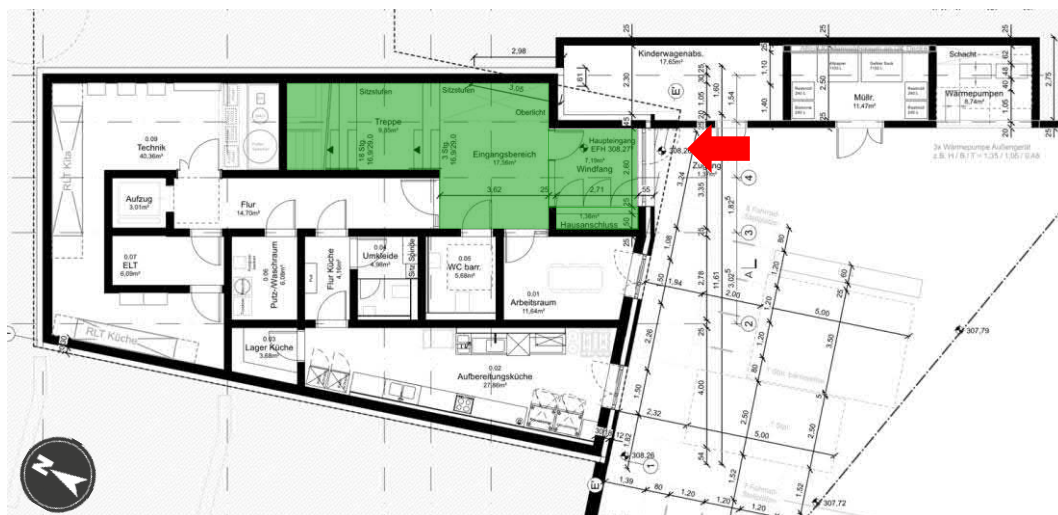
| Grundriss Erdgeschoss [Quelle: Kamm Architekten PartmbB]
